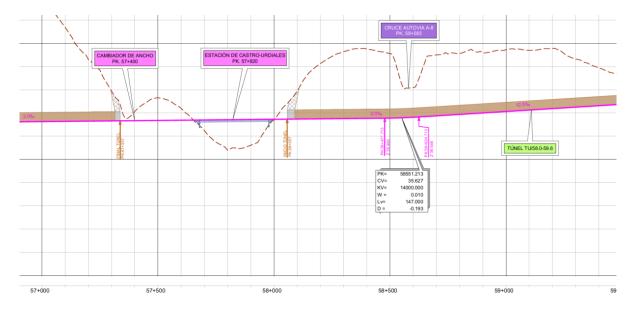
Perfil longitudinal Alternativa A1 rasante baja
